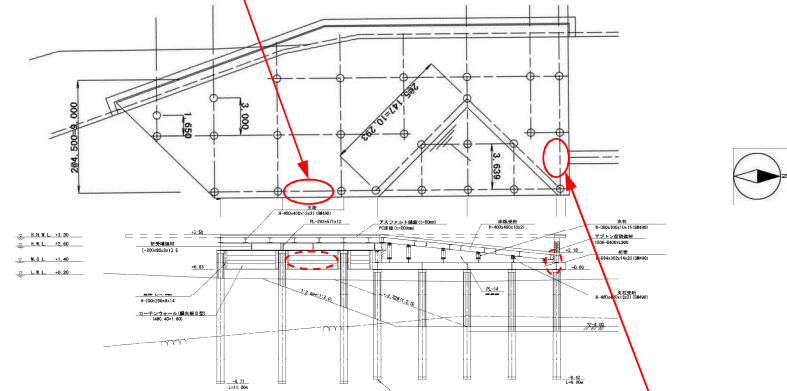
搬出入施設・車両乗降部 平面・横断面図 (カーテンウォール)
